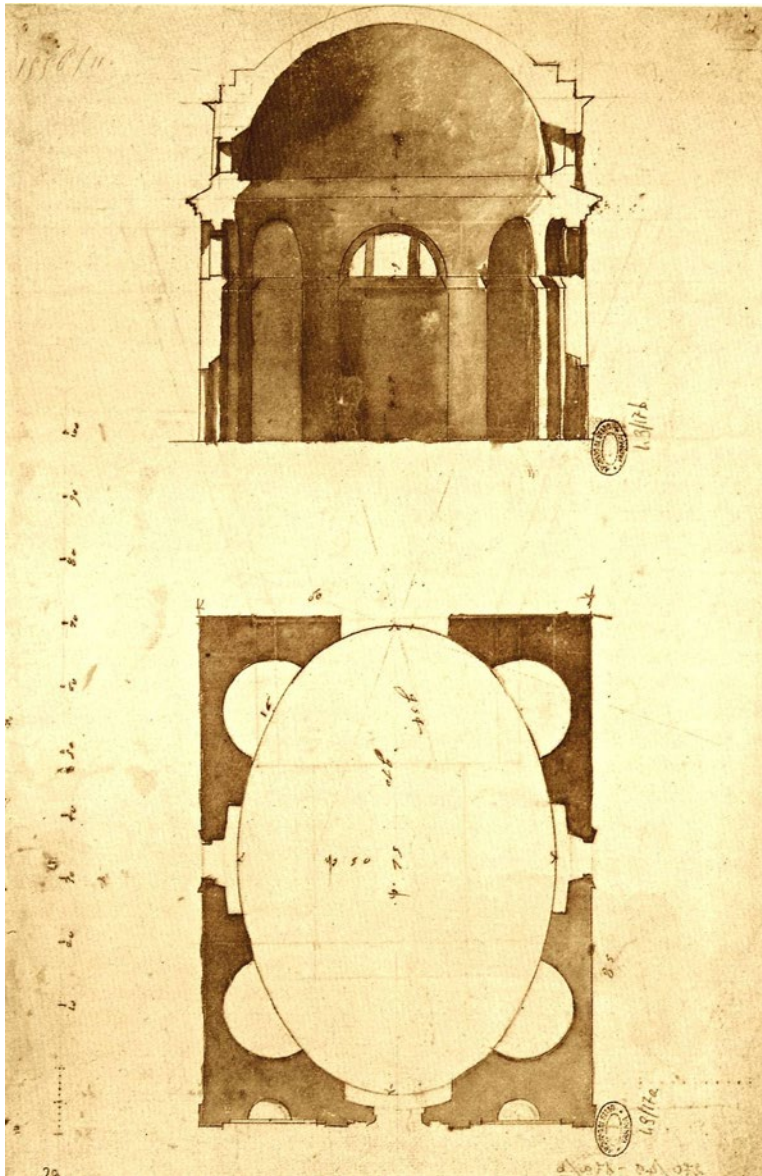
Jacopo Barozzi da Vignola, pianta e sezione trasversale di una piccola chiesa ovale. ASPr, *Fabbriche non appartenenti allo Stato, Piante e disegni*, vol. 49, n. 17.
